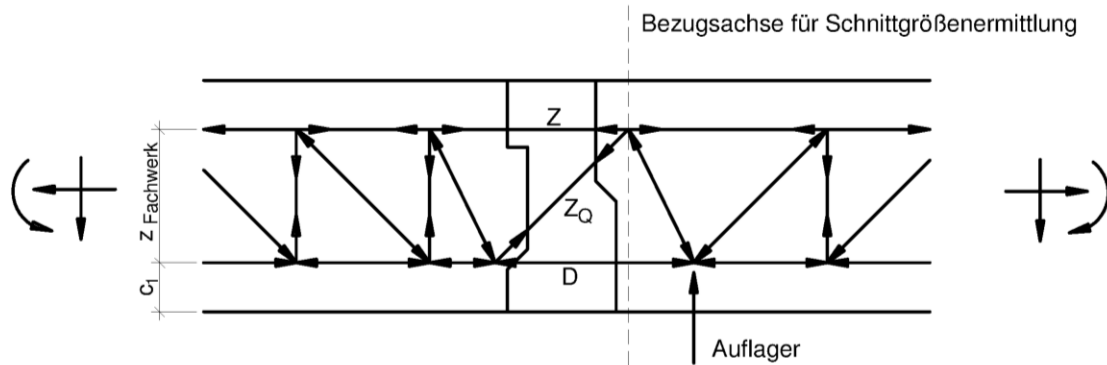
Schöck Isokorb[®] Typ K, Typ KF und Typ KX
